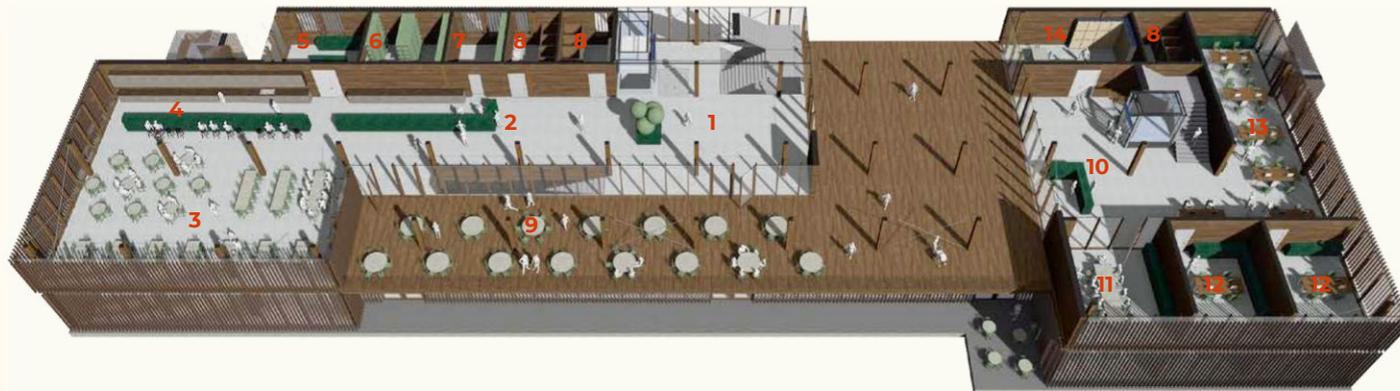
Grundriss Waldwanderweg 1:400
